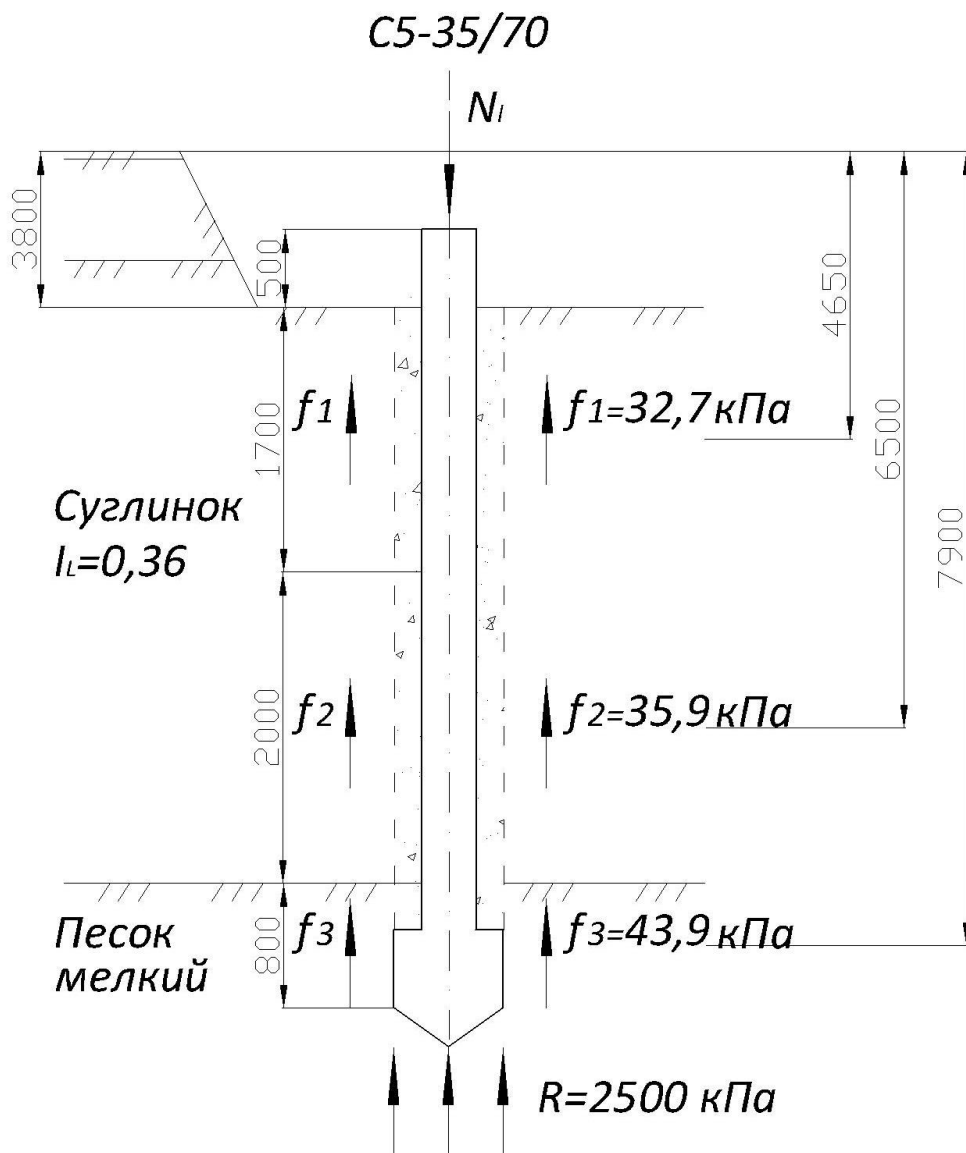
Расчетная схема фундамента, состоящего из свай с наконечником.
